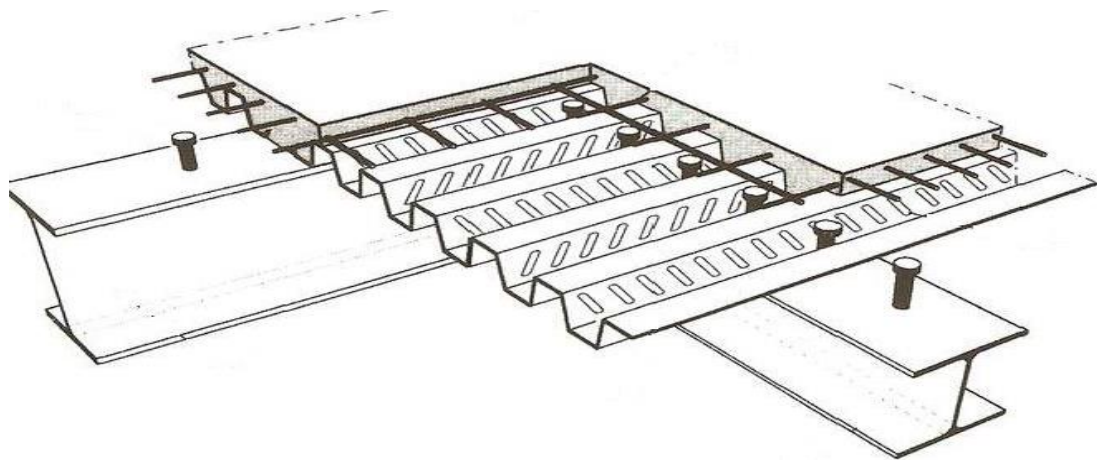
3 : Représentation de la liaison entre une dalle mixte et les poutres porteuses par goujons connecteurs.
